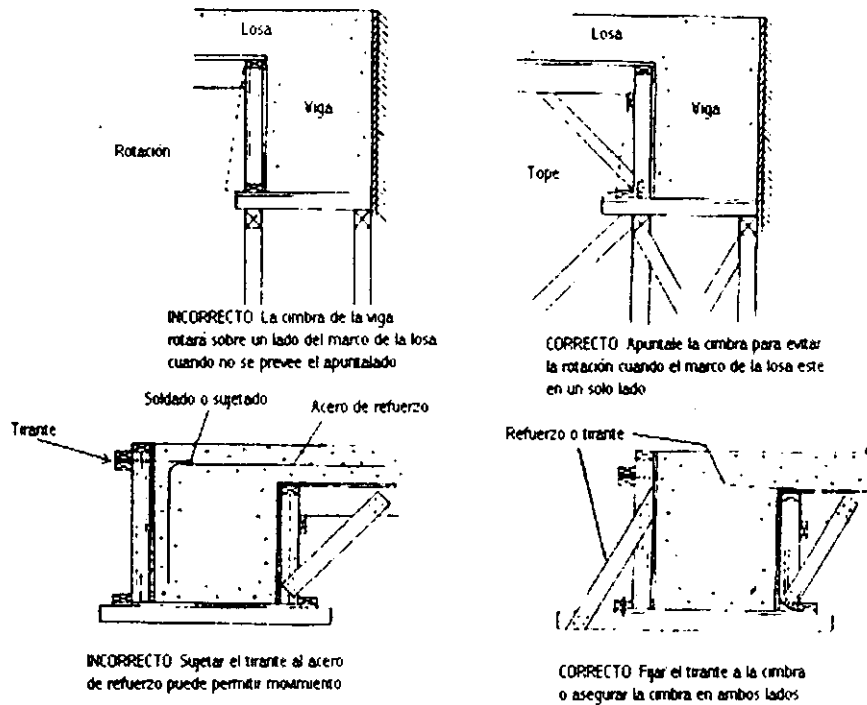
Es importante la prevención de la rotación de la cimbra en las esquinas de las losas y vigas cuando se forma el marco solamente en un lado.
